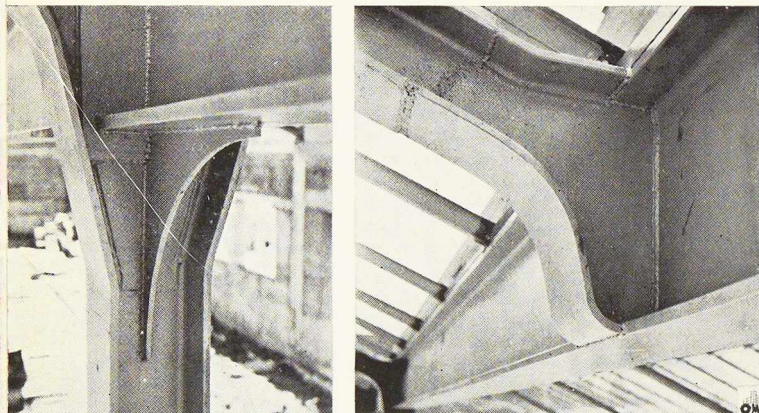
et 9. Gousset trapézoïdal soudé à la tête des poteaux (à gauche) et console assurant l'assemblage des sablières aux fermes (à droite).
